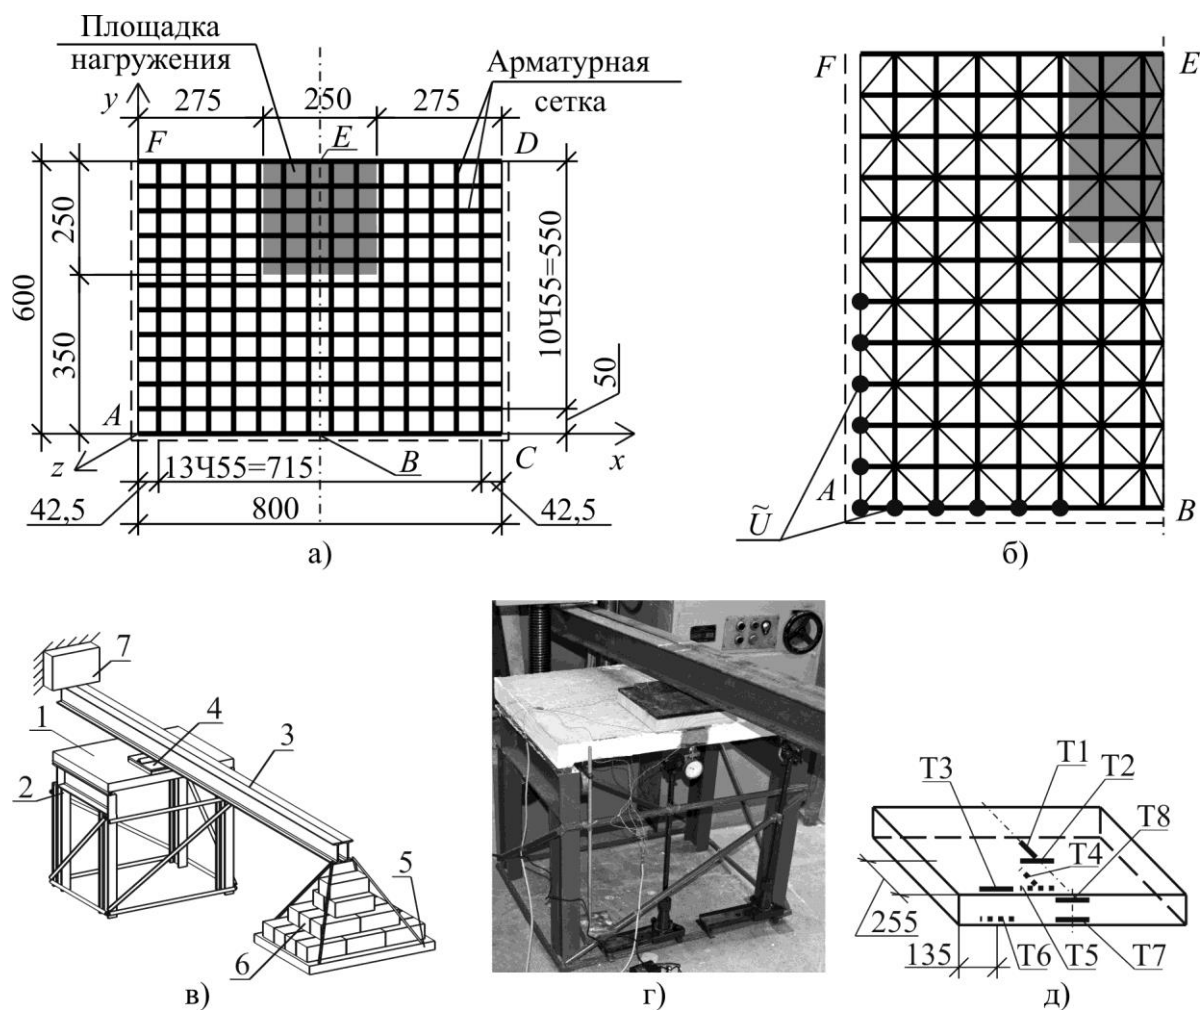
а – Схема железобетонной плиты; б – система конечных элементов бетона и арматуры; в, г – эскиз и фото экспериментальной установки; д – расположение тензорезисторов: 1 – плита; 2 – опорная рама; 3 – балка-рычаг; 4 – штамп нагружения; 5 – поддон для грузов; 6 – грузы; 7 – опора рычага
